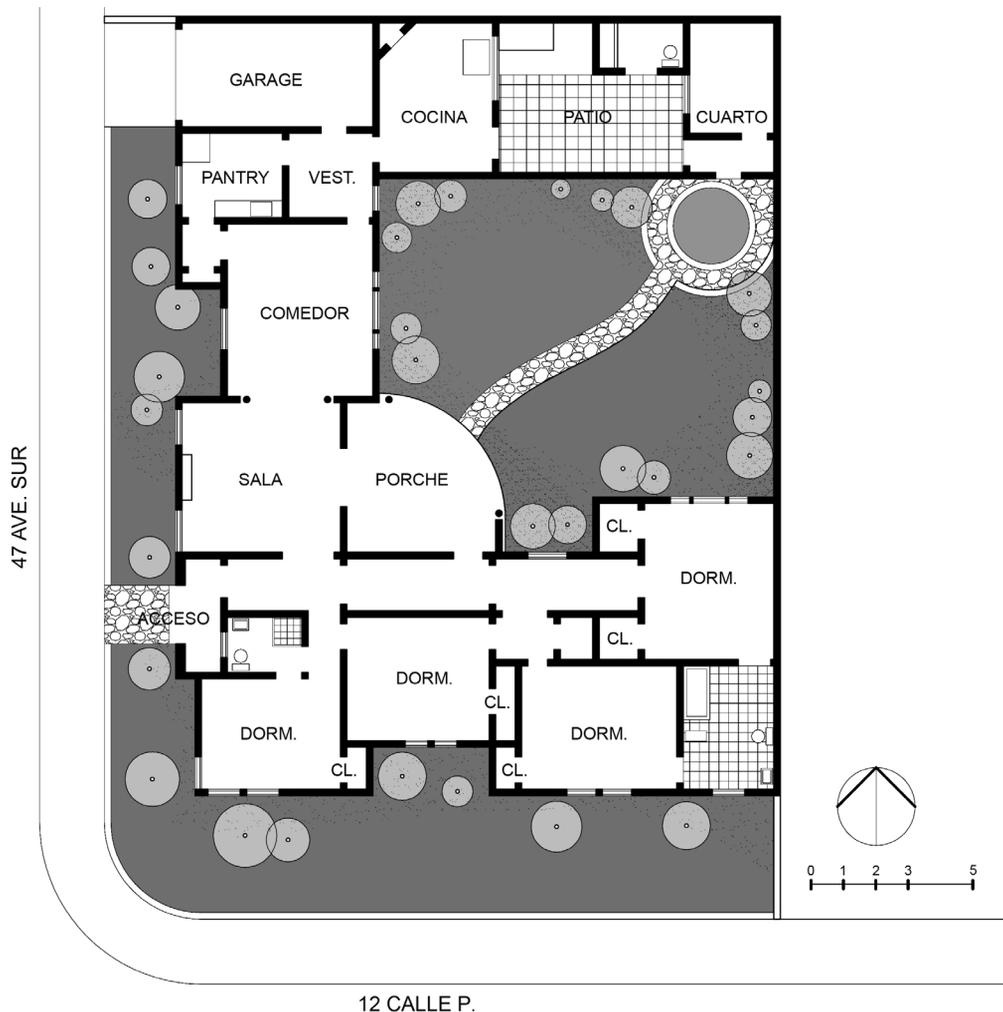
Planta arquitectónica casa Schildknecht, Col. Flor Blanca, San Salvador
